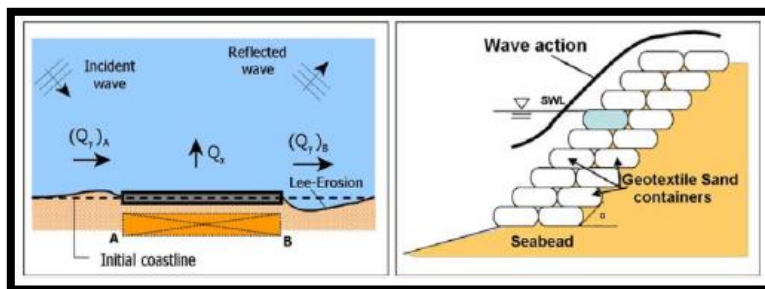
Muro hecho a partir de GSCs (vista en planta y perfil).
